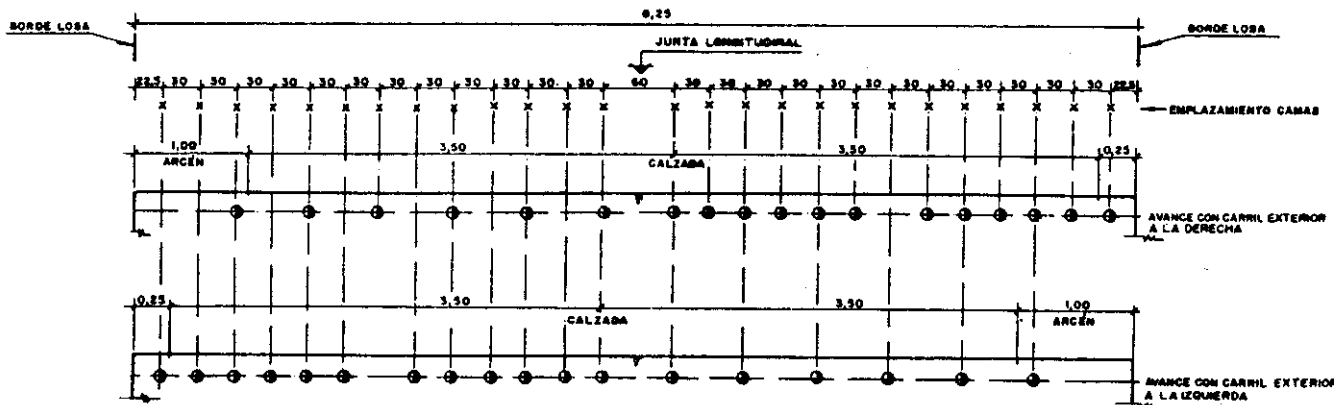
Un ejemplo de distribución de pasadores en un pavimento de hormigón vibrado
